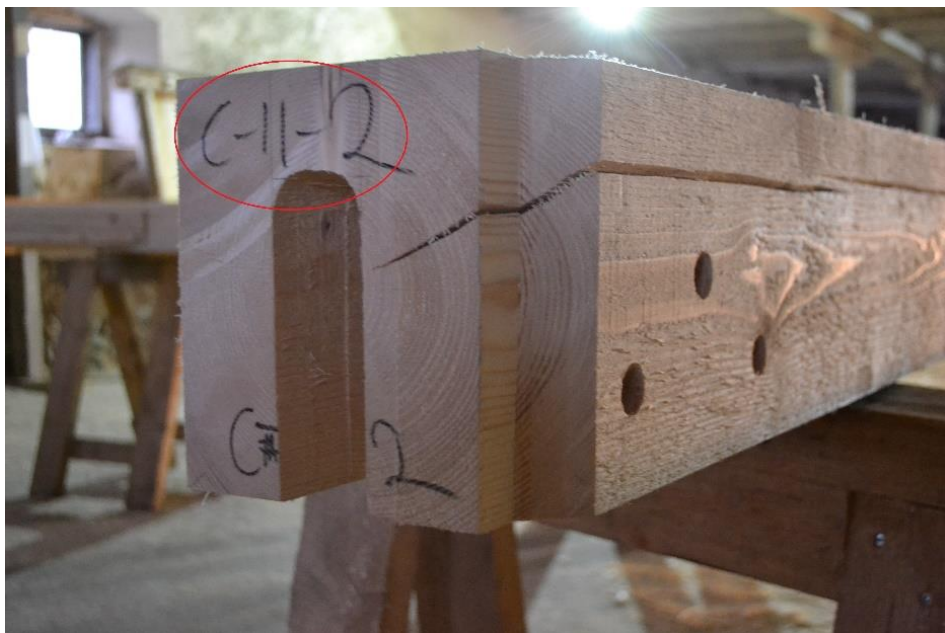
Konstruksioonidetaili asukohta määrav tähis C-II-2. Autori foto
